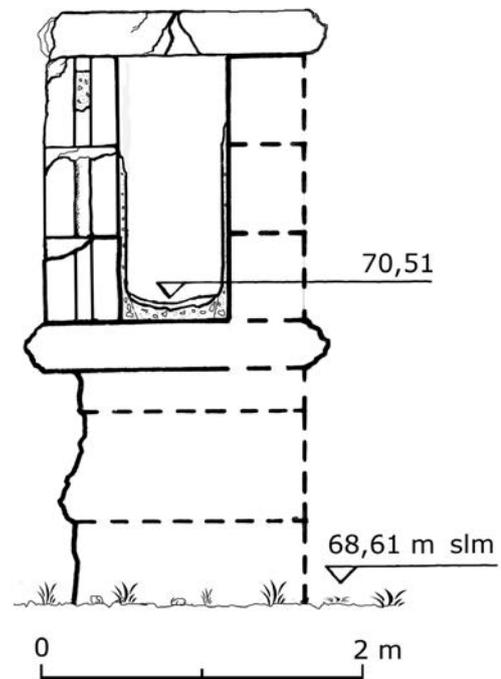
AREA 1. Sezione prospettica A-B dell'infrastruttura (rilievo in scala 1:50 dell'A., 2019).
